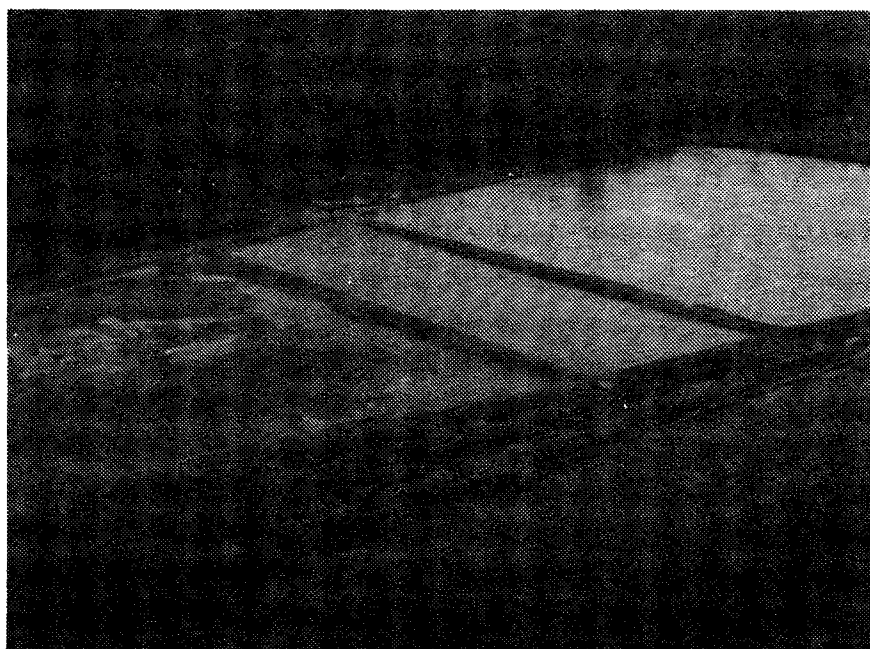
Construcción de piscinas camaroneras en tierras altas.
